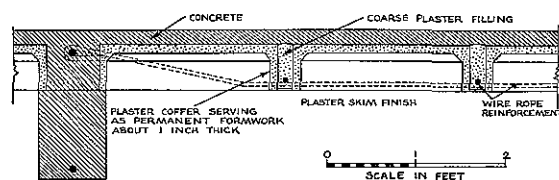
Delvis præfabrikeret engelsk jernbetondækkonstruktion fra midten af 1850'erne - »W. B. Wilkinson's floor and ceiling construction« (»A History of Technology, V«).
